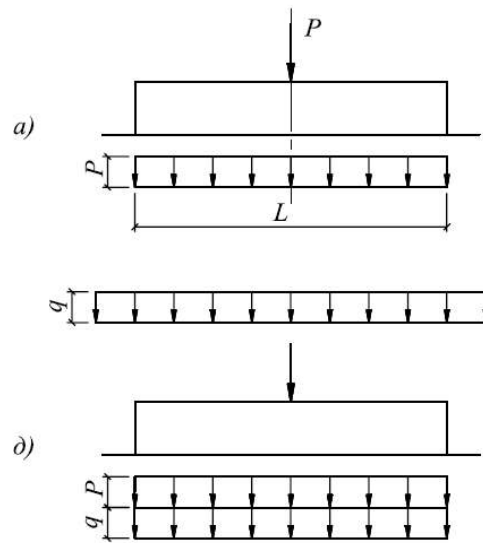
Эпюры давлений по подошве фундаментов при центральной нагрузке. а и д – при центральной нагрузке
